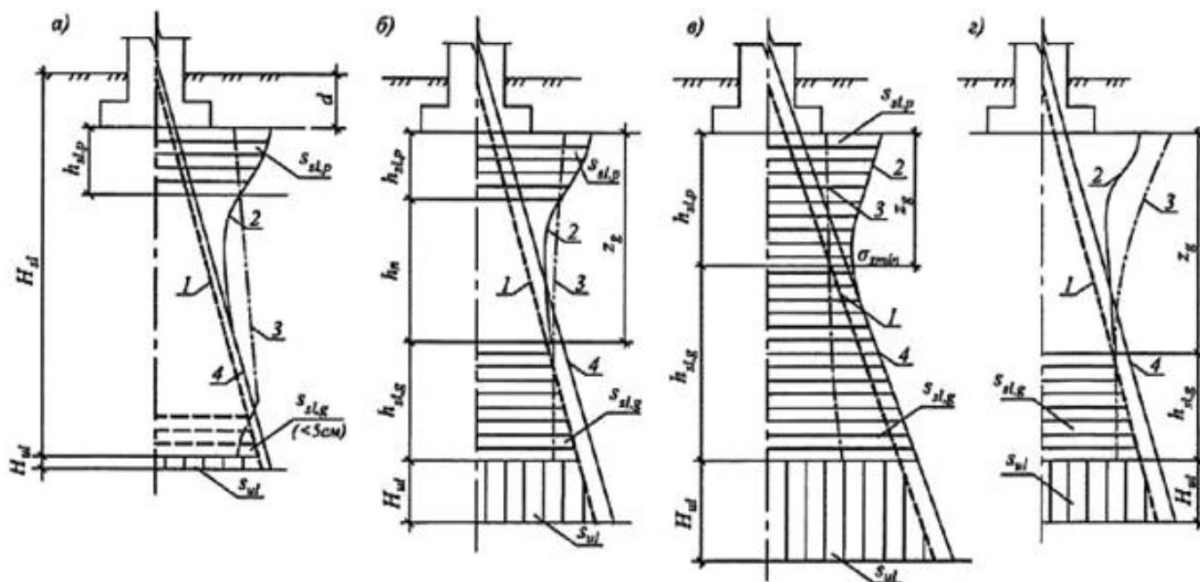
Схемы к расчету просадок грунта в основании фундамента
